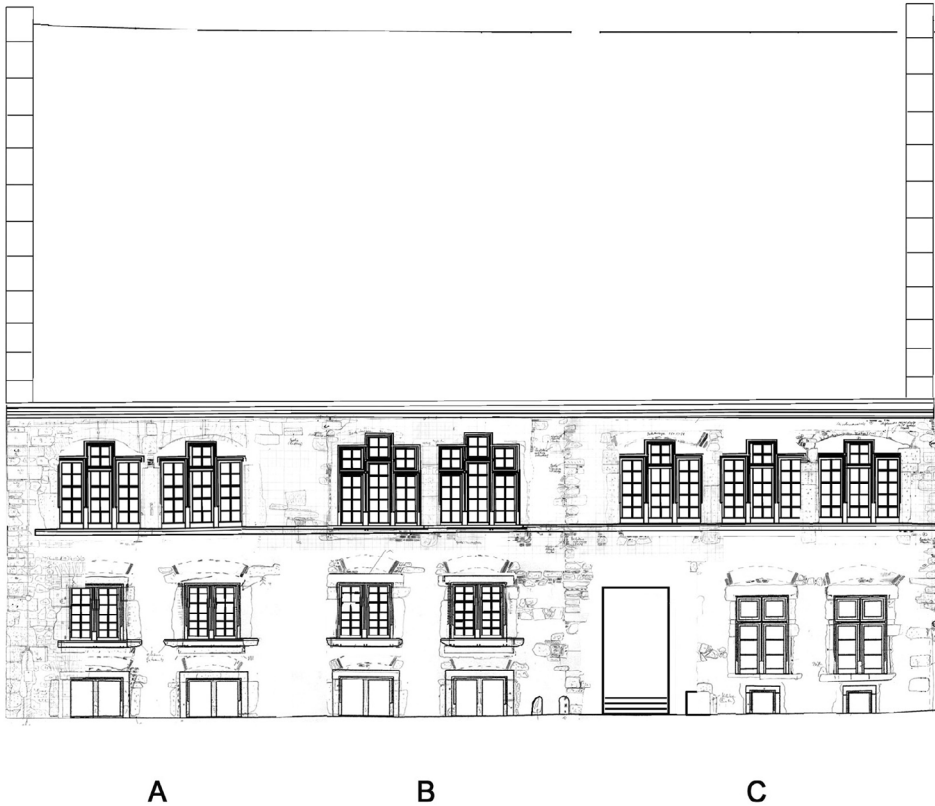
Freiburg, Historisches Kaufhaus – Rekonstruktion der Straßenfassade im 16. Jahrhundert. Plan: Frank Löbbecke, 2010.
